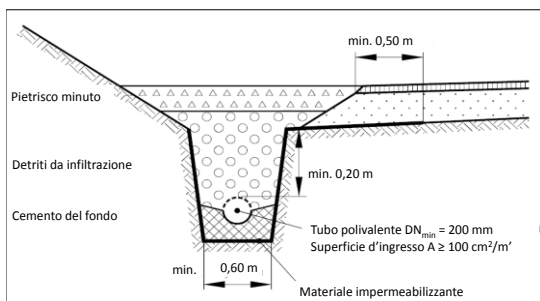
Tipo 4b - Evacuazione con impermeabilizzazione del fosso
